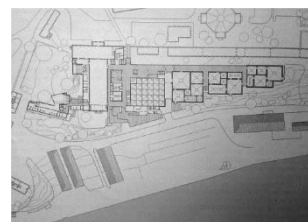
Planta baja de la actuación. Encuentro de vías
